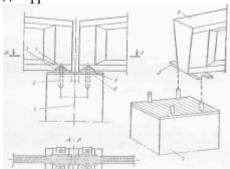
Соединение ригеля с колонной на анкерных болтах н монтажной сварке.
